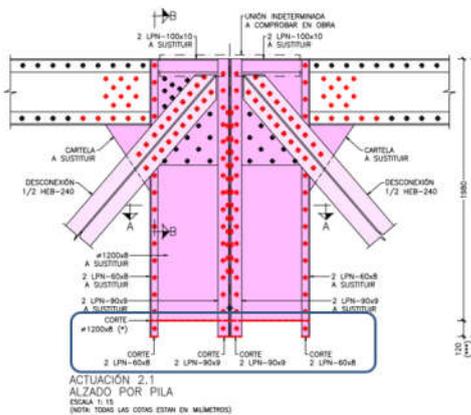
Nudo superior mamparo de pila. Corte de perfiles
